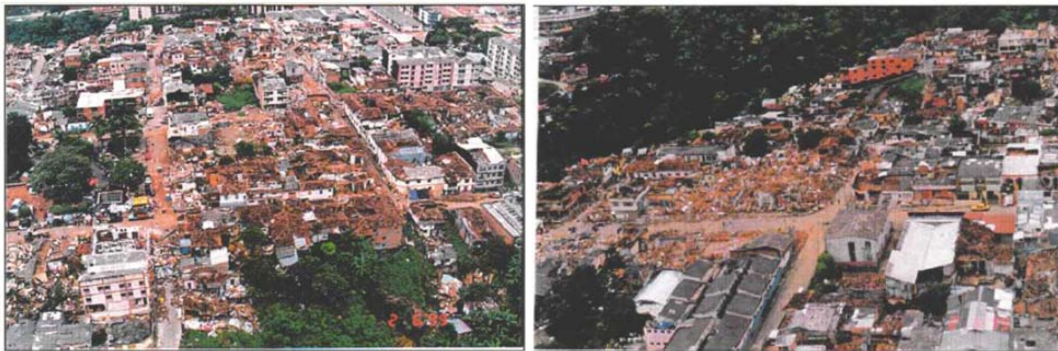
Colapso general de viviendas de mampostería no reforzada en Armenia (Terremoto del Eje Cafetero, 1999).
